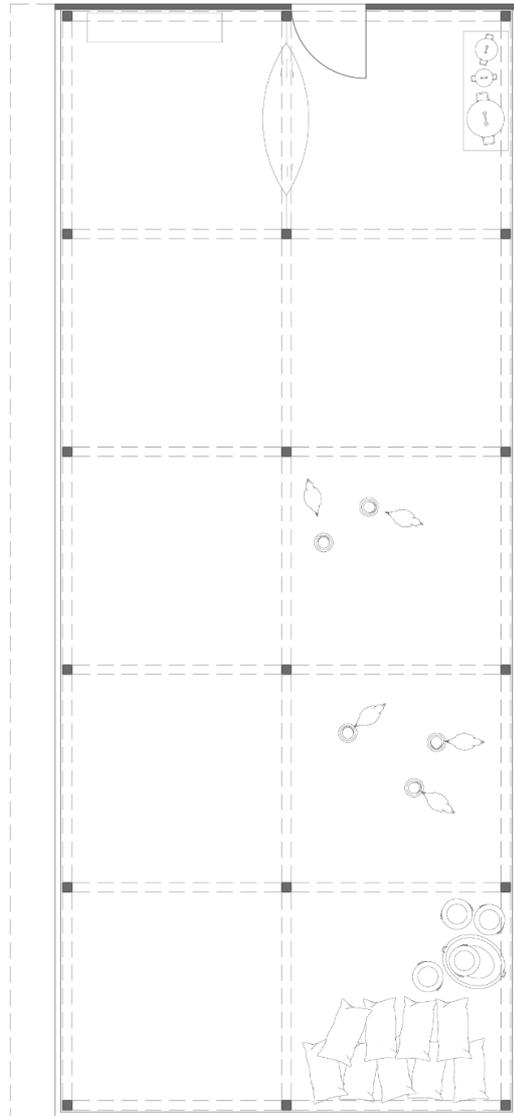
Planta baja de la uka de concreto de Dimas Córdoba.
